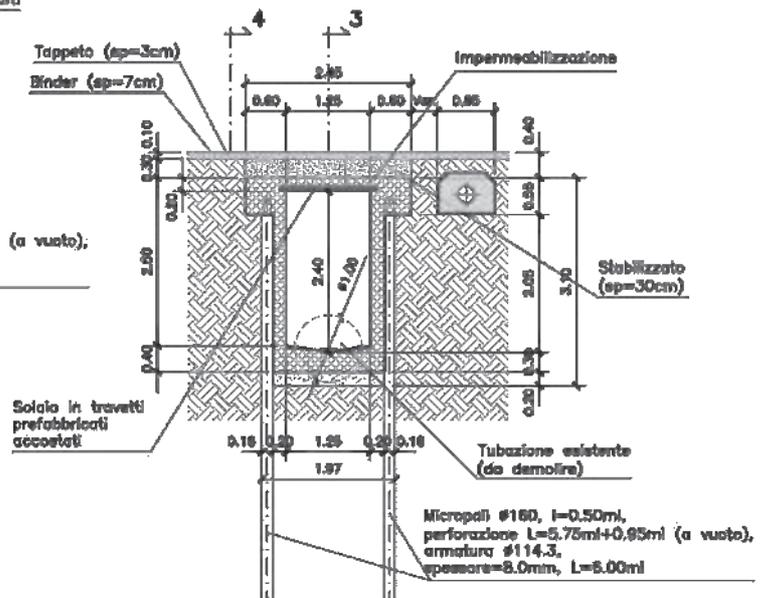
Sezioni trasversali tipo di progetto (secondo lotto)
